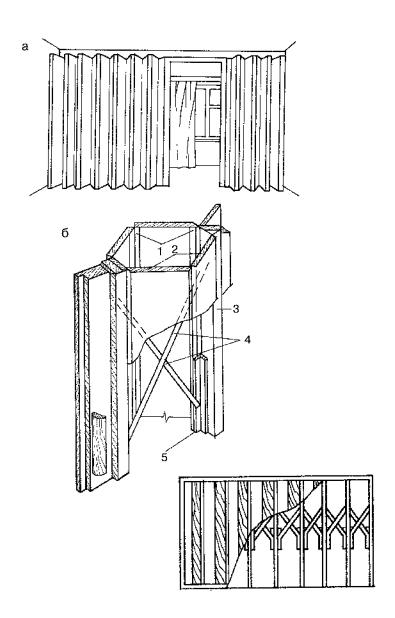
Складные двери: а — общий вид; б — конструкция звена; 1 — рояльные петли; 2 — многослойная фанера; 3 — брусок; 4 — «ножницы»; 5 — металлический уголок
